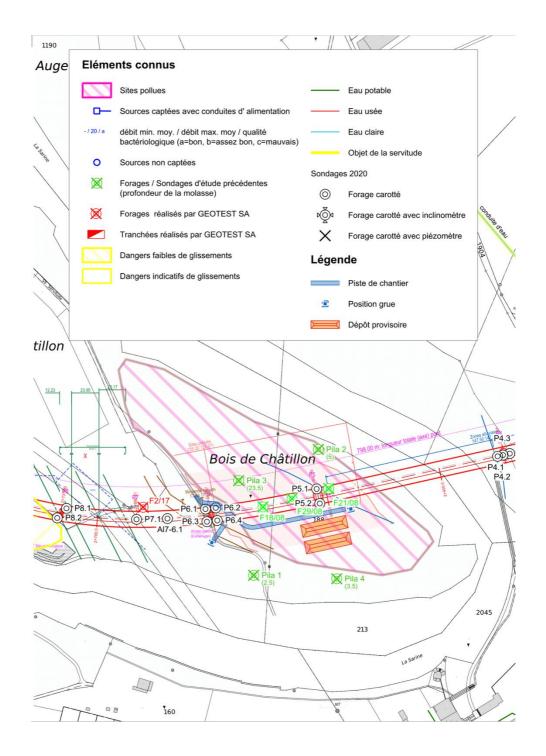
Situation du projet et principaux ouvrages (fond de plan : swisstopo)
